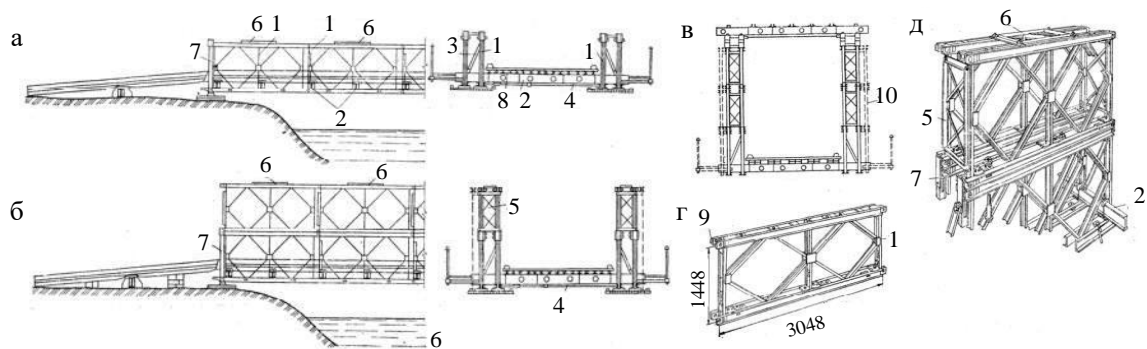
Конструкції мосту Bailey: а – з подвійними фермами; б – двоярусна прогонова будова з подвійними головними фермами; в – троярусна прогонова будова (пунктиром показано встановлення третьої ферми та тротуарів); г – плоска секція головної ферми; д – схема конструкції кінцевої панелі двоярусної ферми; 1 – плоска секція головної ферми; 2 – поперечна балка; 3 – підкіс, що забезпечує стійкість одиночної ферми для малих прогонів; 4 – нижні зв'язки; 5 – плоска рамка поперечного зв'язку ферм; 6 – рамка горизонтальних зв'язків ферм; 7 – кінцева підсилена стійка; 8 – поздовжні балки проїзної частини; 9 – вуха стику поясів; 10 – місце встановлення третьої ферми
